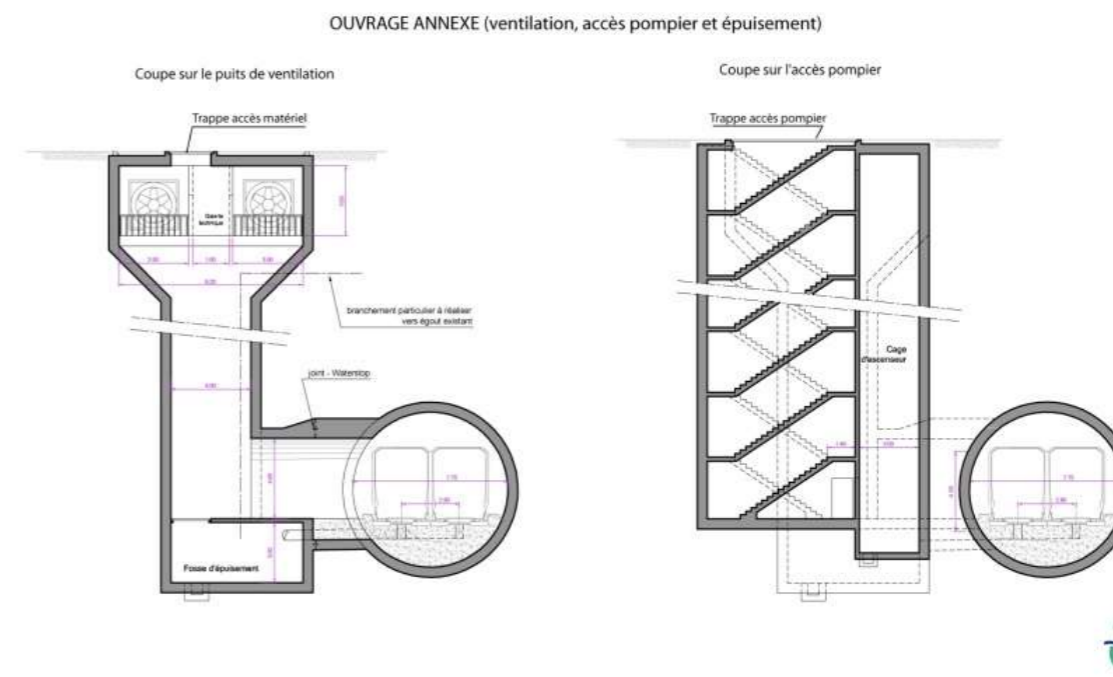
Coupes des ouvrages puits de ventilation et accès pompiers (Source : RATP)
